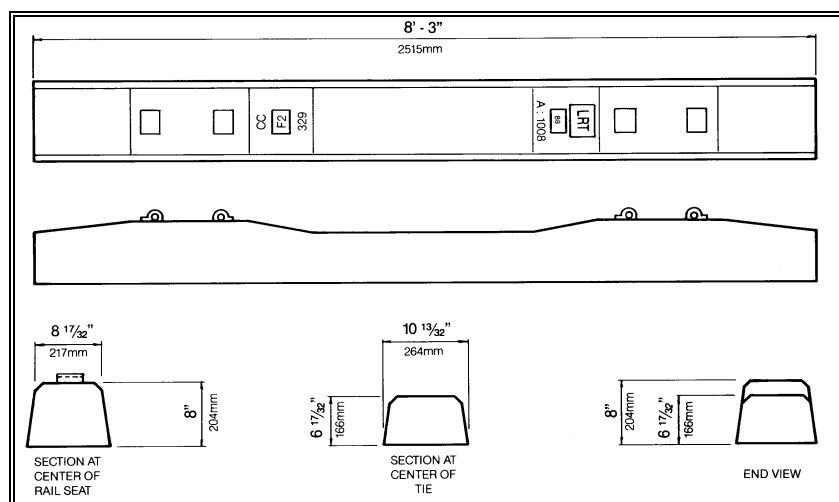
Dormente modelo CC329-F2 para via leve (FONTE: CXT CONCRETE RAILROAD TIES).
